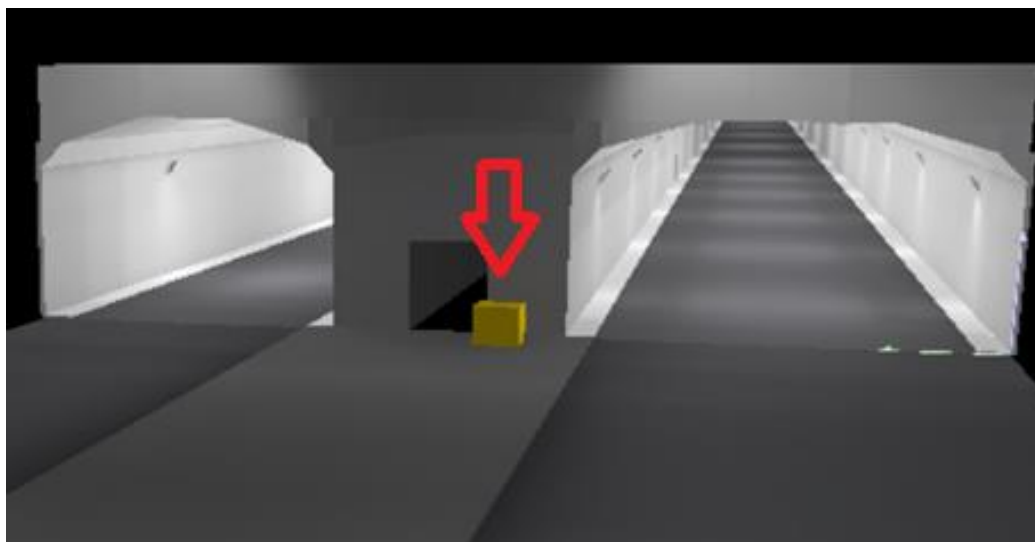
Emplazamiento Centro de Seccionamiento (C.S.) en entrada del Túnel Sur y Salida del Túnel Norte
